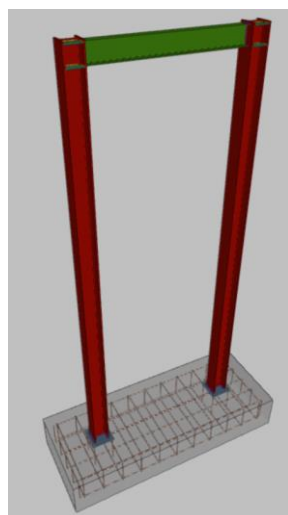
'Estructura y cimentación Monolito Informativo' (CYPE3D)
